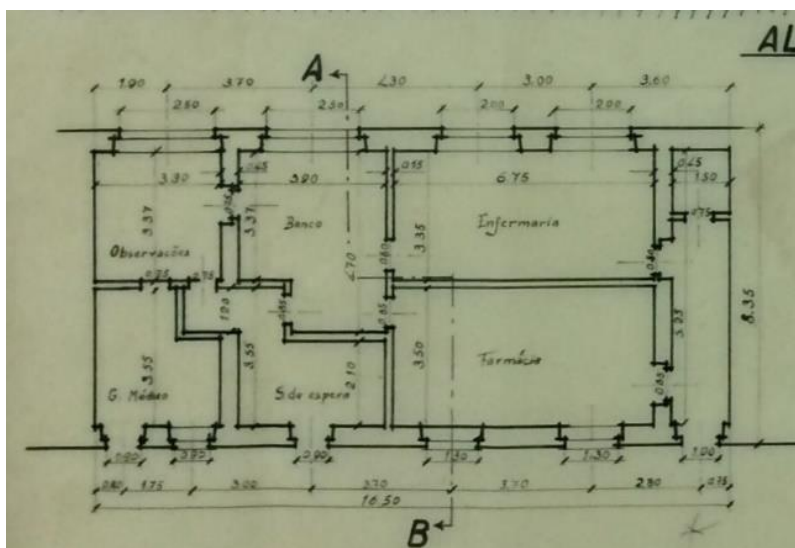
Planta de 1949 - Enfermaria e Farmácia © MML.
